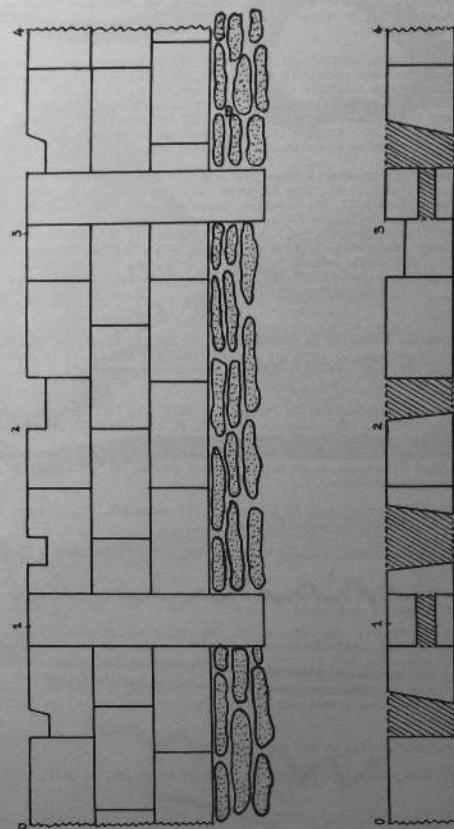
Plan du Murus Dacicus. Blocs taillés, piliers verticaux et trous pour la fixation des pentes transversales et longitudinales. Echelle 1/20.
